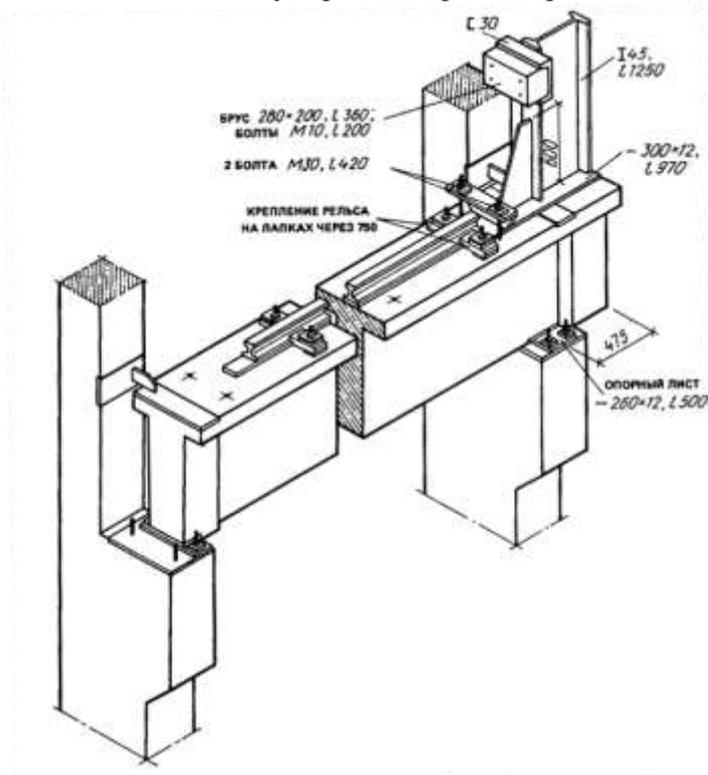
Опираие подкрановой балки на консоль колонны и конструкция концевого упора
